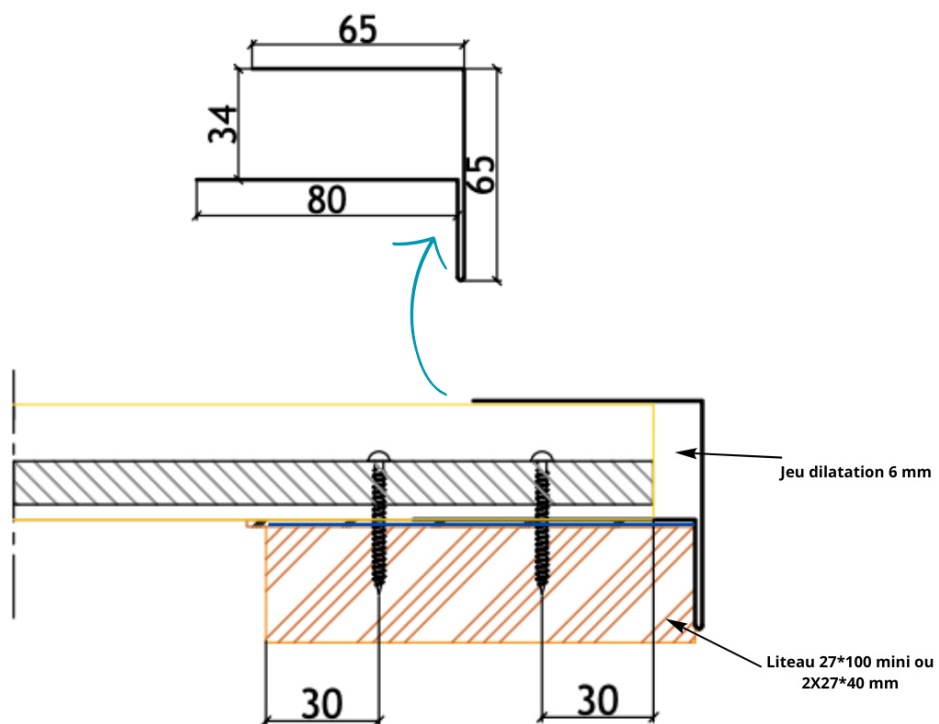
Coupe verticale : départ et arrêt haut bardage sur OB en pose verticale
